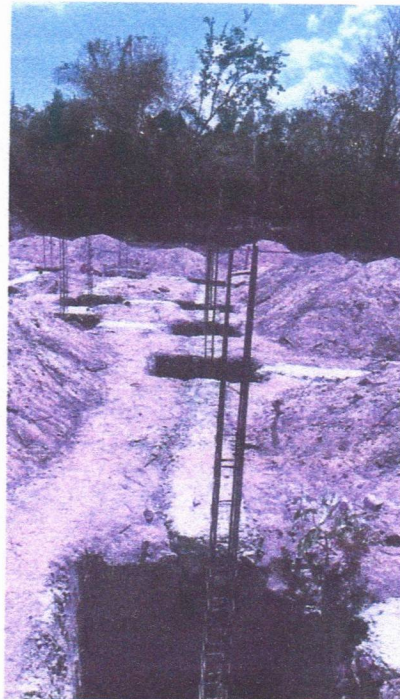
Execução do gabarito da obra, escavações das fundações, alicerce com pedra argamassada, e concretagem das sapatas.
